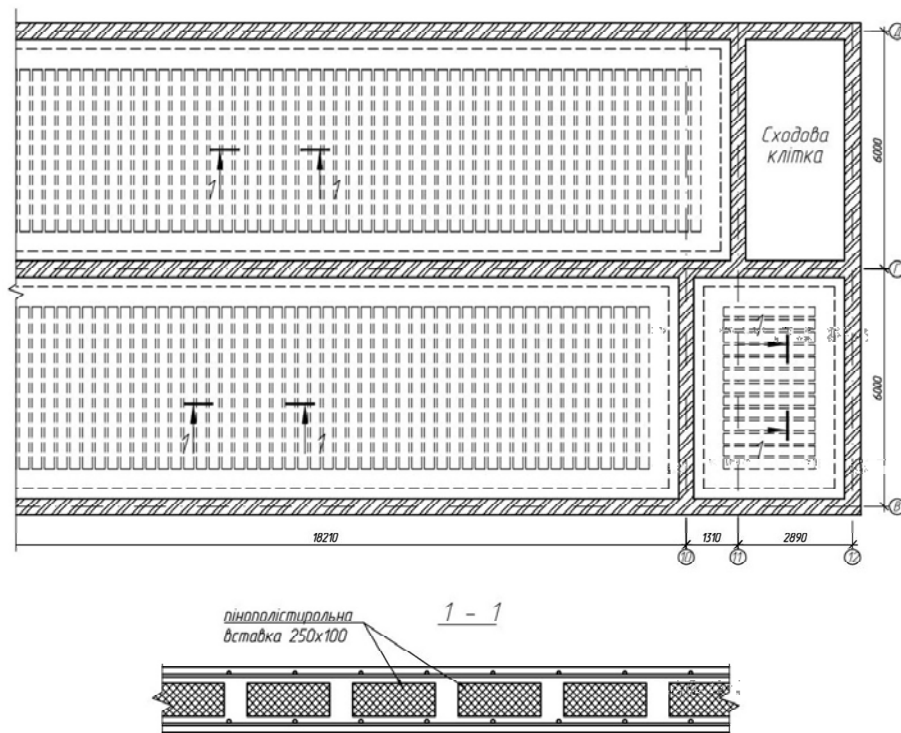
Розташування вставок в плані і перерізі фундаментної монолітної залізобетонної плити будинку по вул. Лемківській у м. Львові
